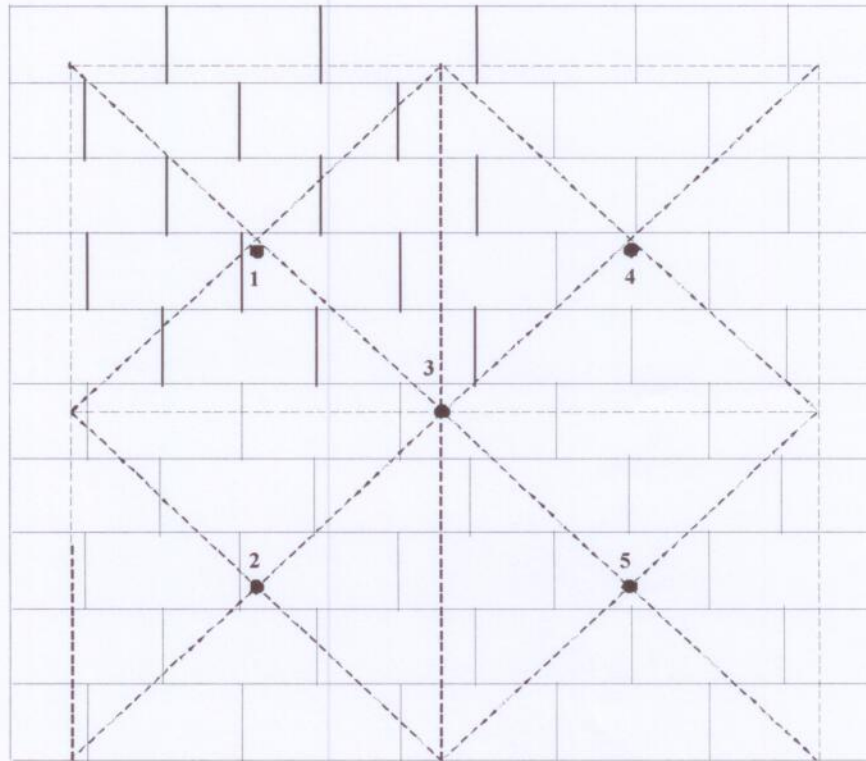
Схема расстановки термопар на необогреваемой стороне образца
